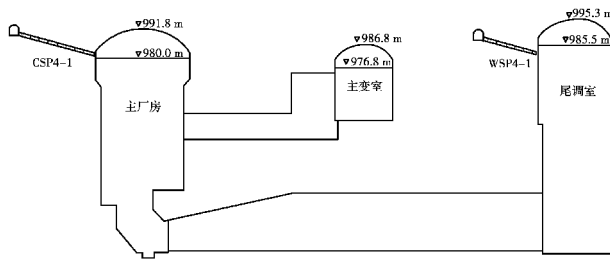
地下厂房洞室群施工开挖及测试孔布置示意图
